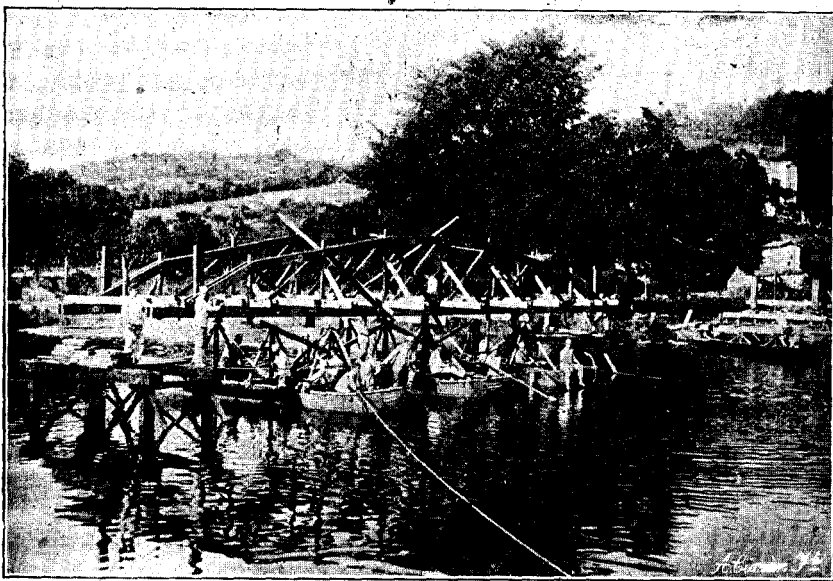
Maniobra para la colocación del tramo central en el puente de Loyola.
